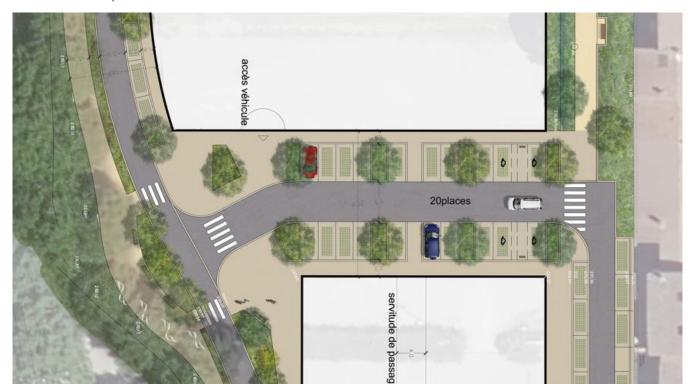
Plan masse zoomé sur le parking public (orientation Nord en haut)
